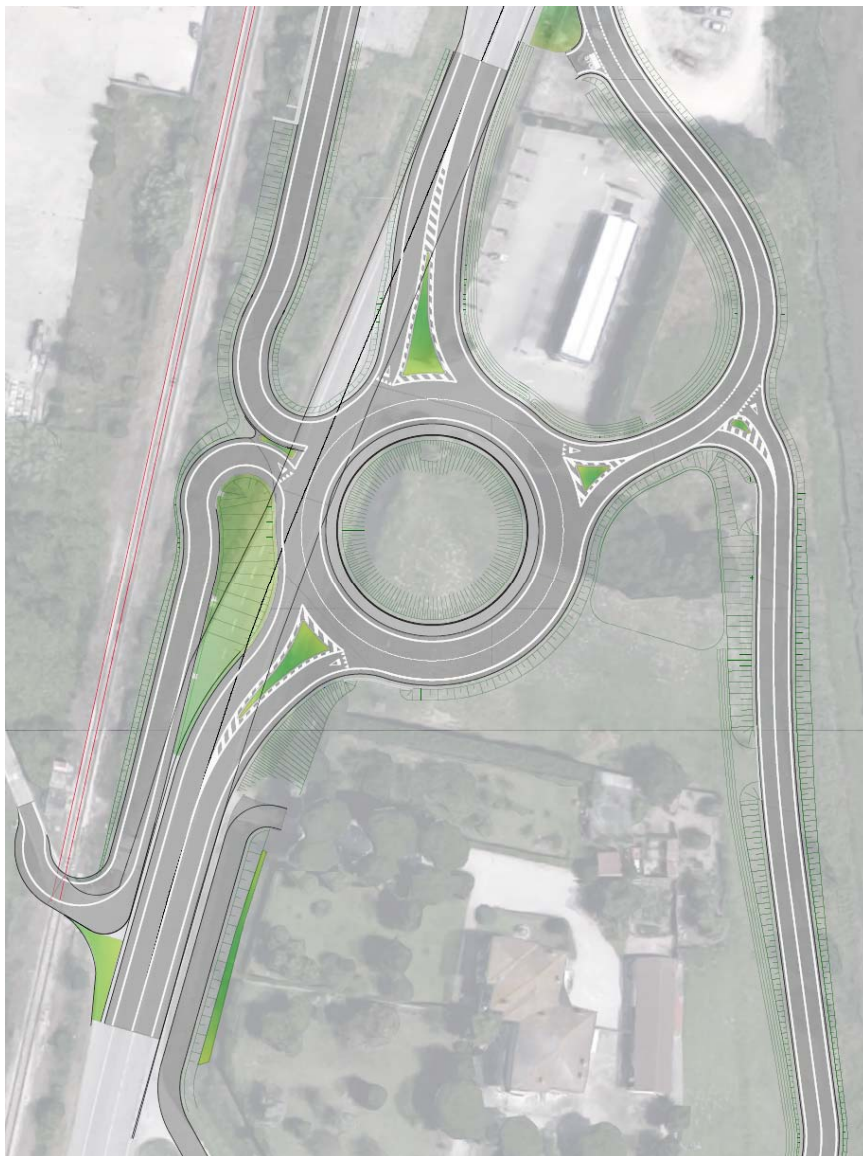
Stralcio della planimetria di progetto della rotatoria
